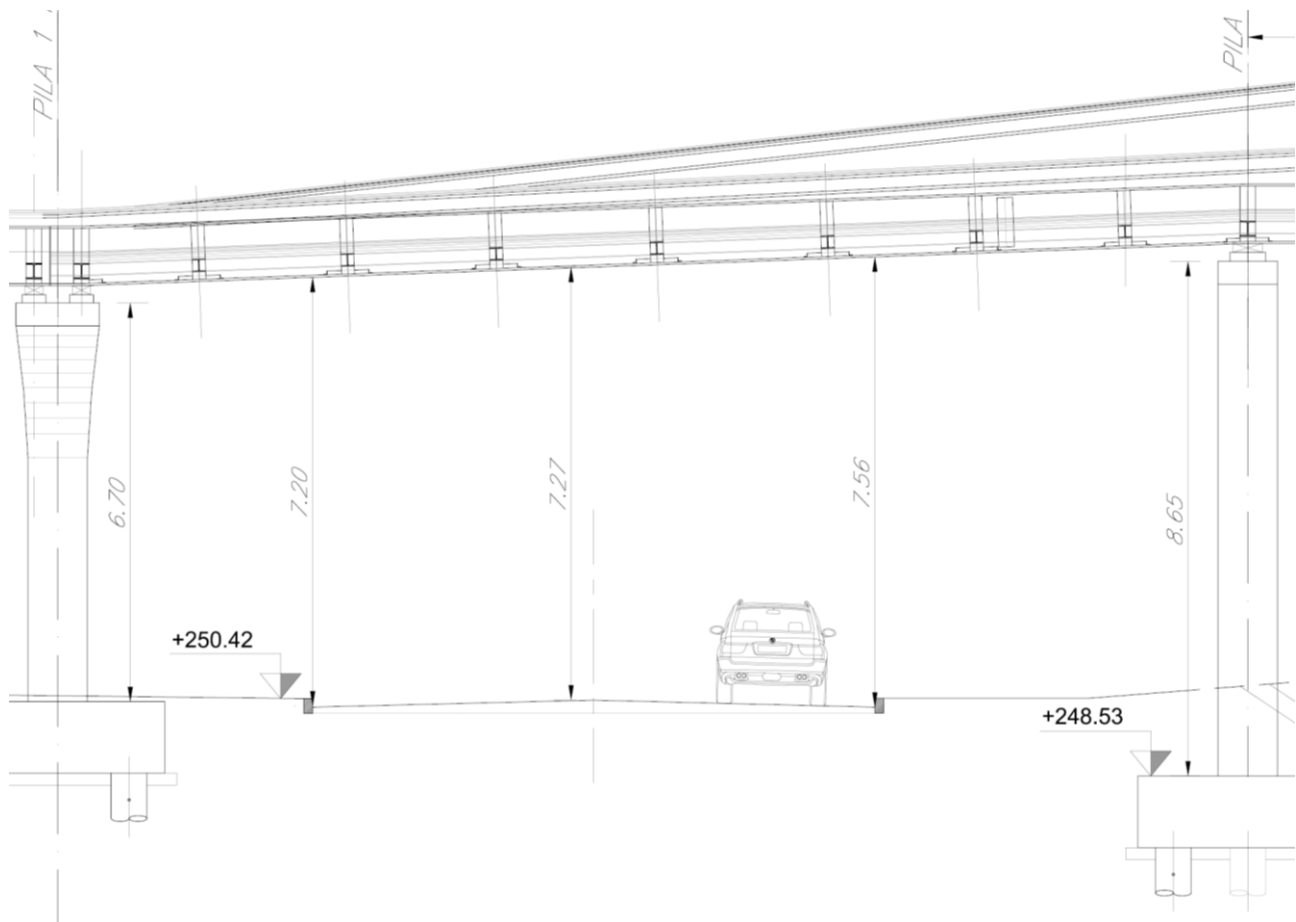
Passerella, prima campata – Sezione longitudinale [m]
